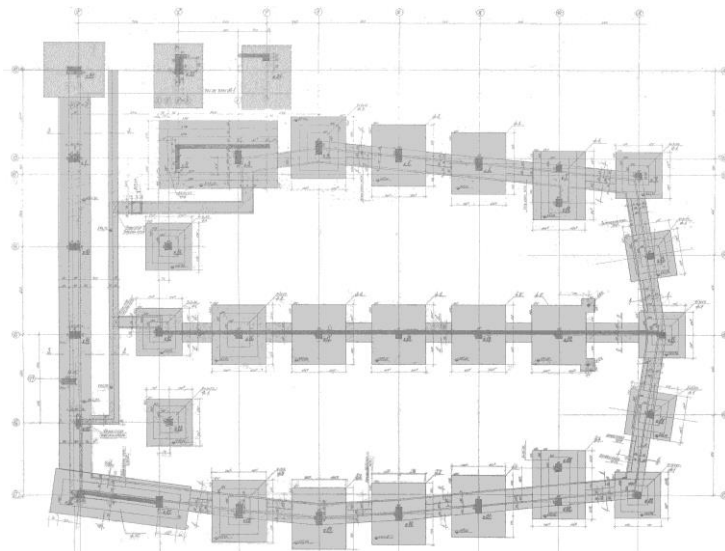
Котражен план на плоча – кота 561,24 на блок 7 на УАСГ
